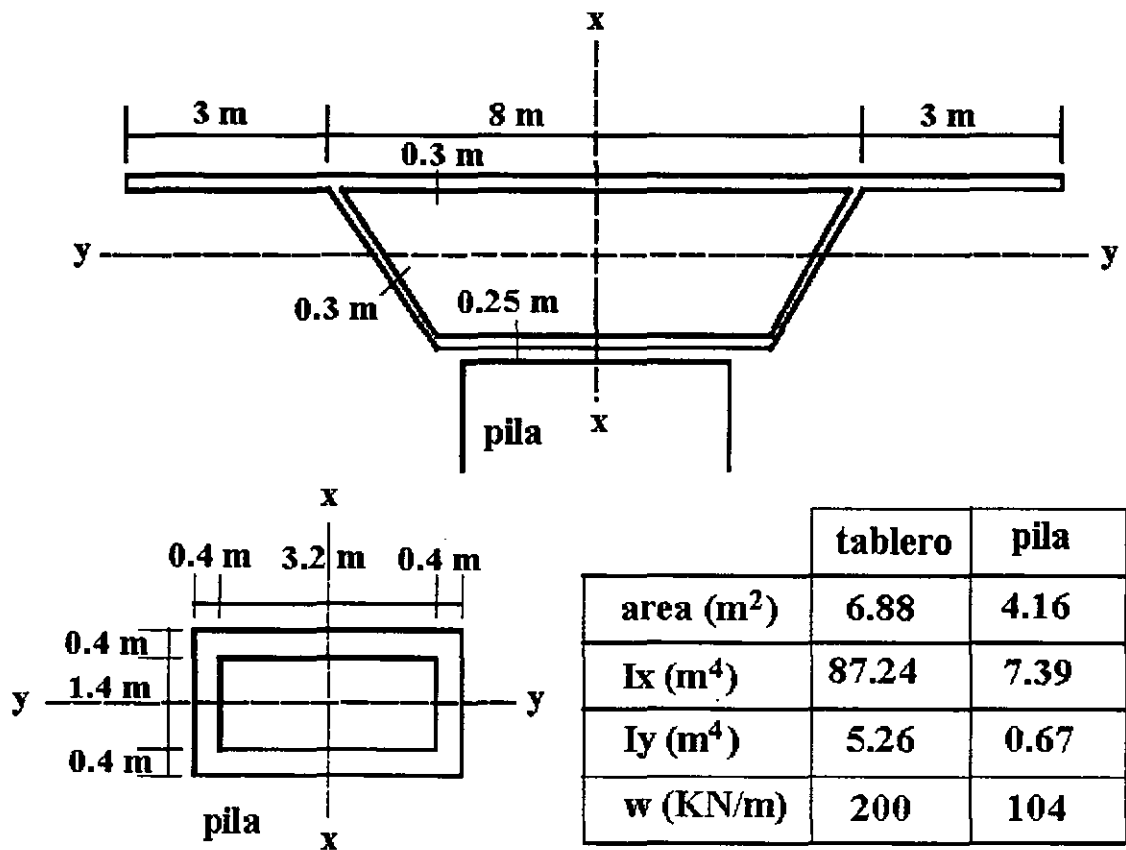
Secciones Transversales del Tablero y las Pilas
